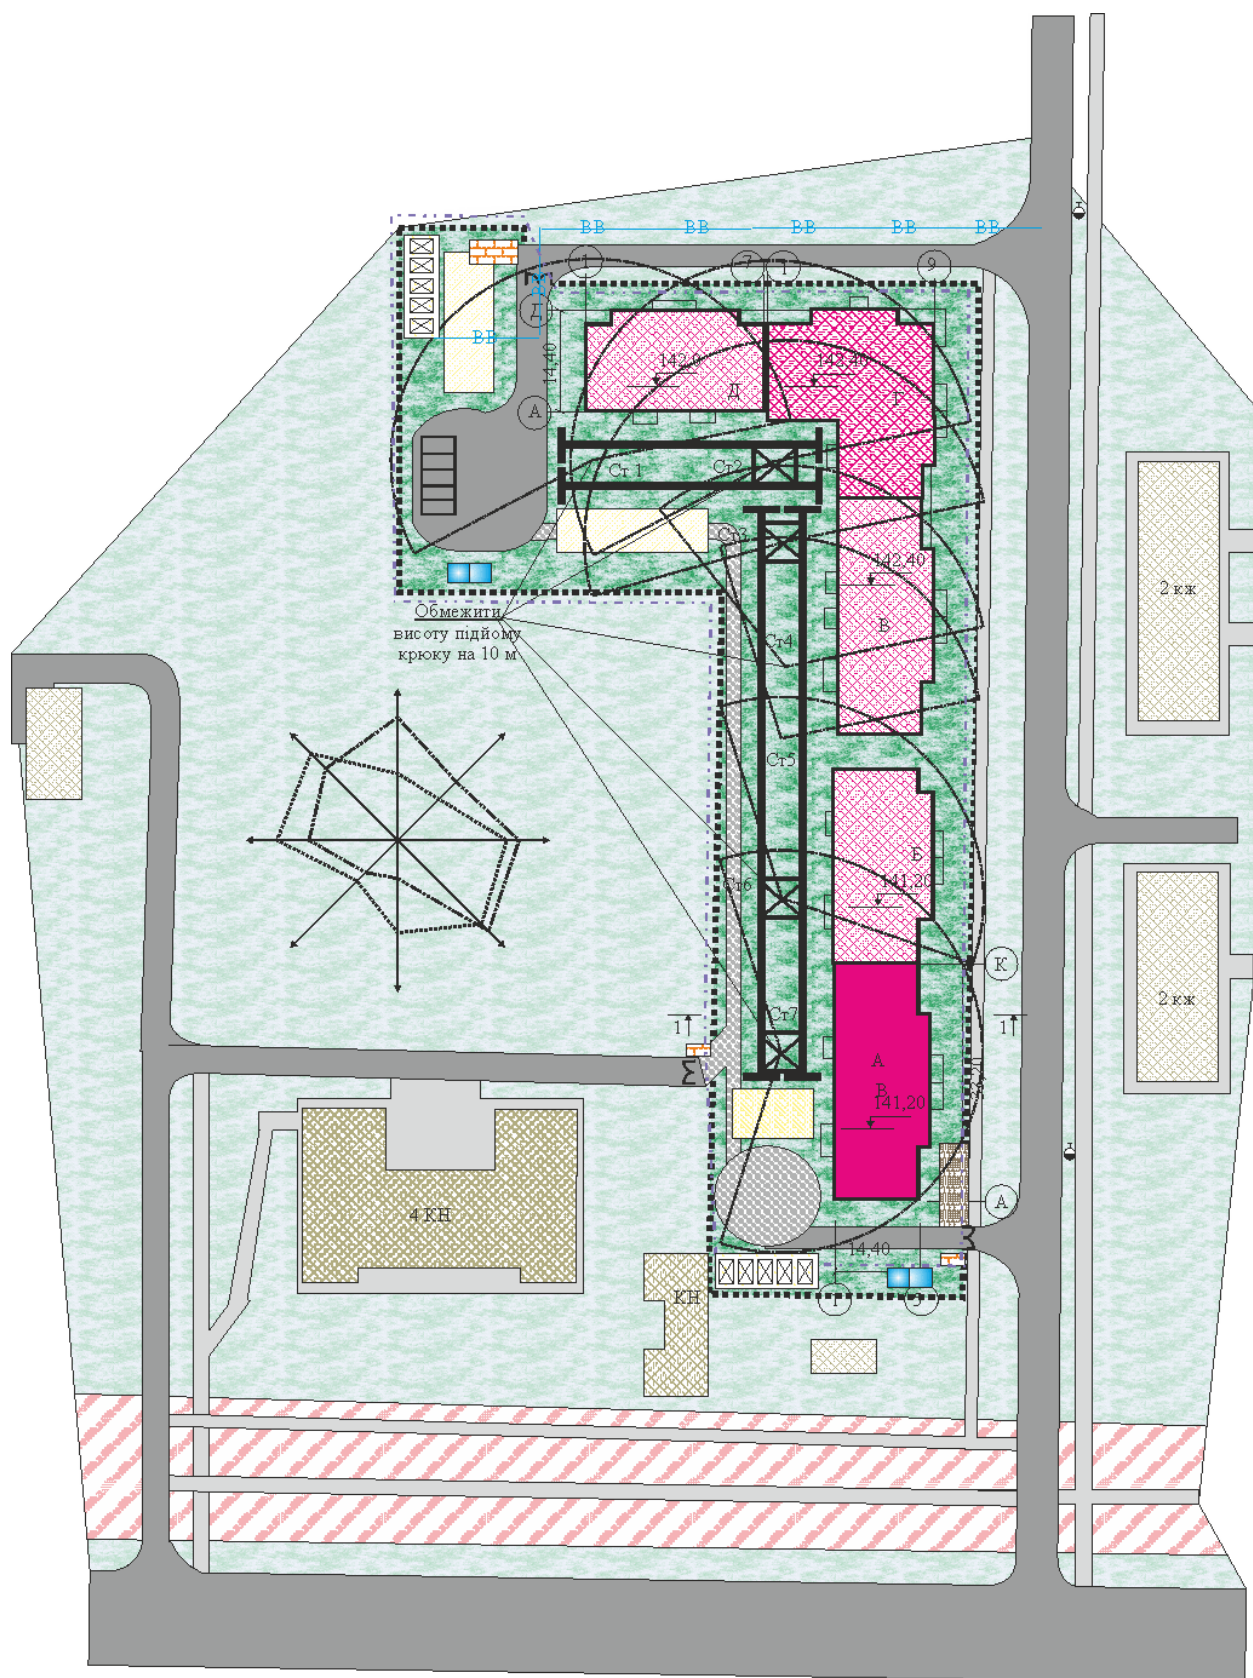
Будгенплан розглянутої зони реконструкції
